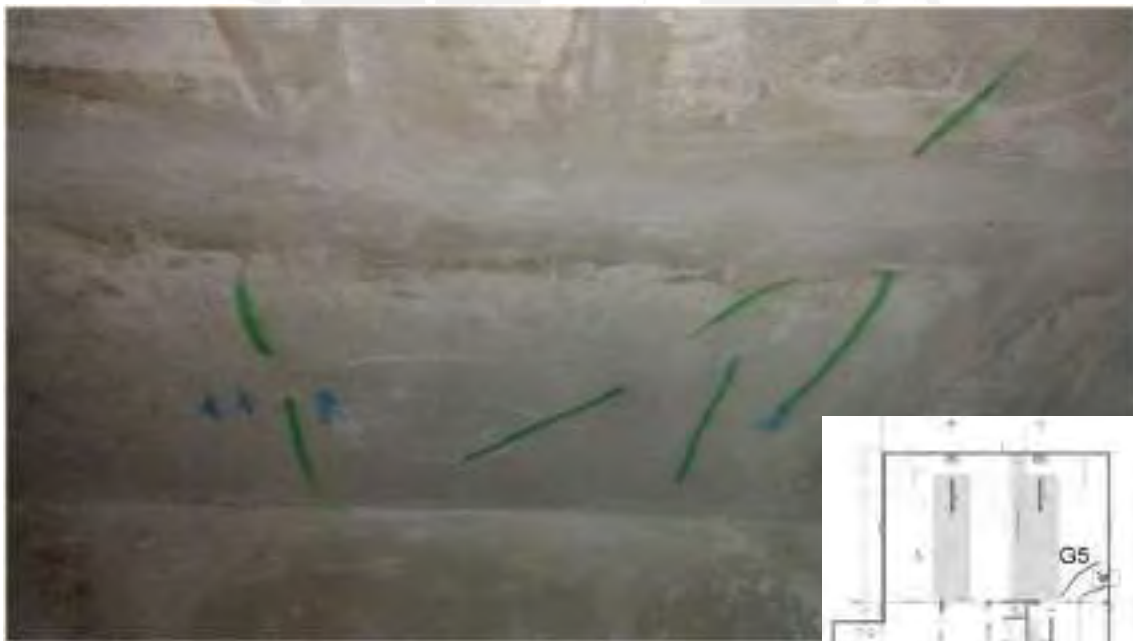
Grupo de Fisuras G5 (3)
